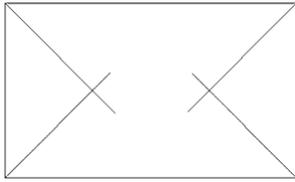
Abbildung III. Die fertige Dachausmittlung des einfachen Walmdachs
